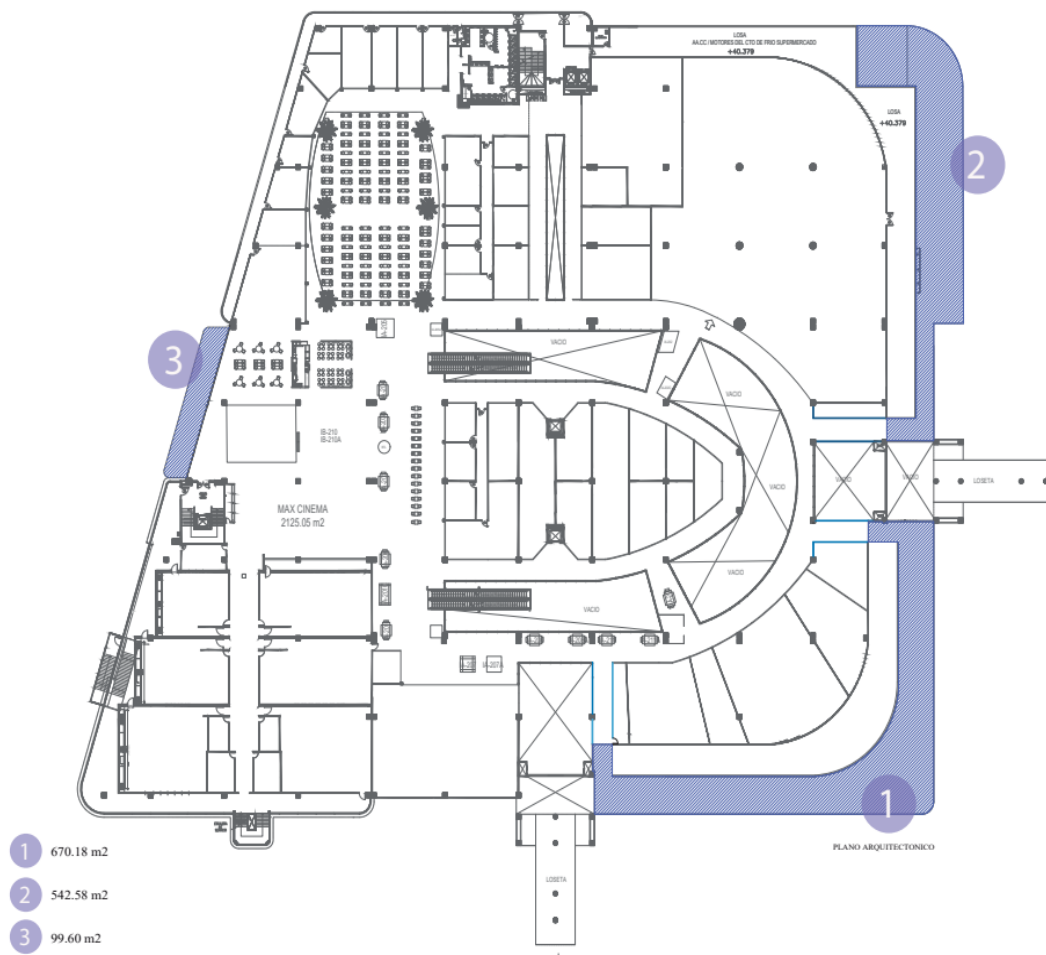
Plano arquitectónico de la planta superior del Centro Comercial Mall El Fortín
